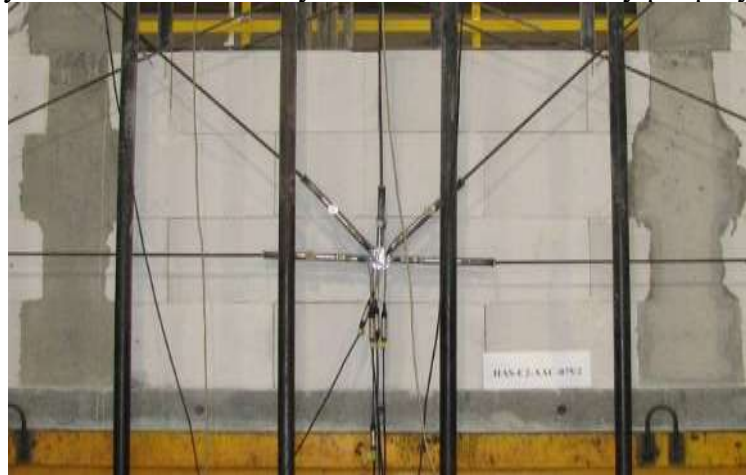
Pierwsze zarysowania w połowie wysokości filarka od strony podpory B
